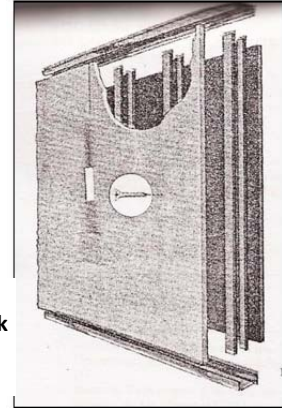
Panel prefabricado de yeso Sheetrock para muros divisorios de Yeso Panamericano S.A.¹³⁰
